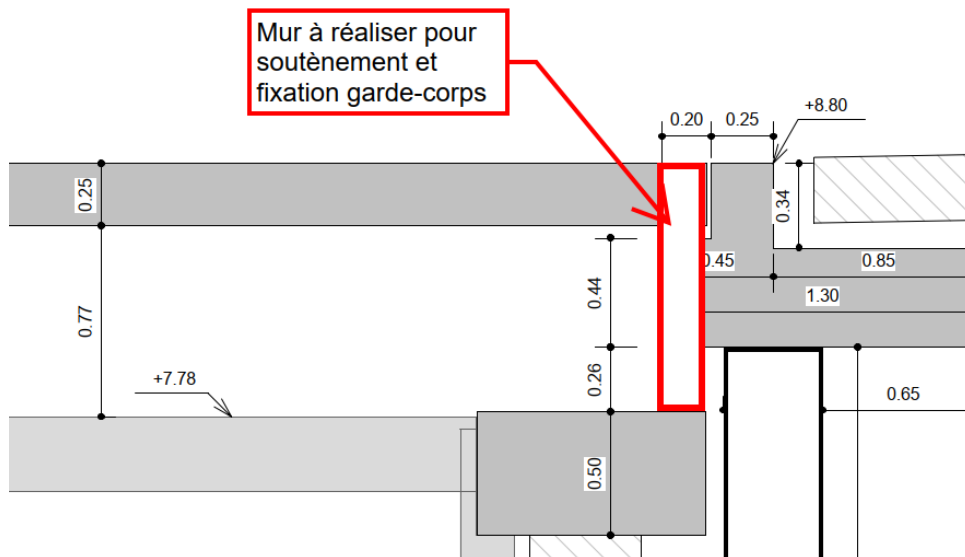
Mur soutènement au-dessus de la poutre de couronnement (solution variante)
